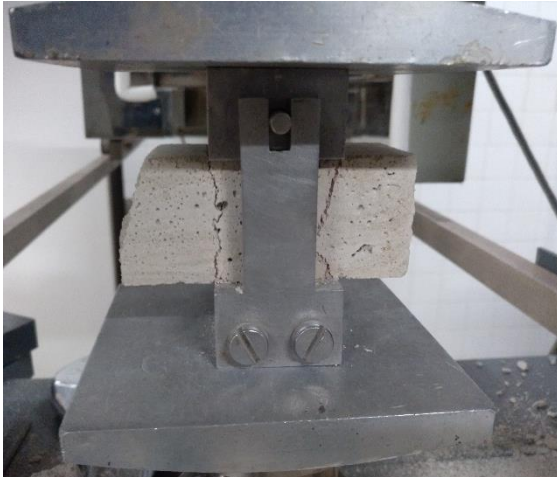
Ensaio à compressão em provete de argamassa.
